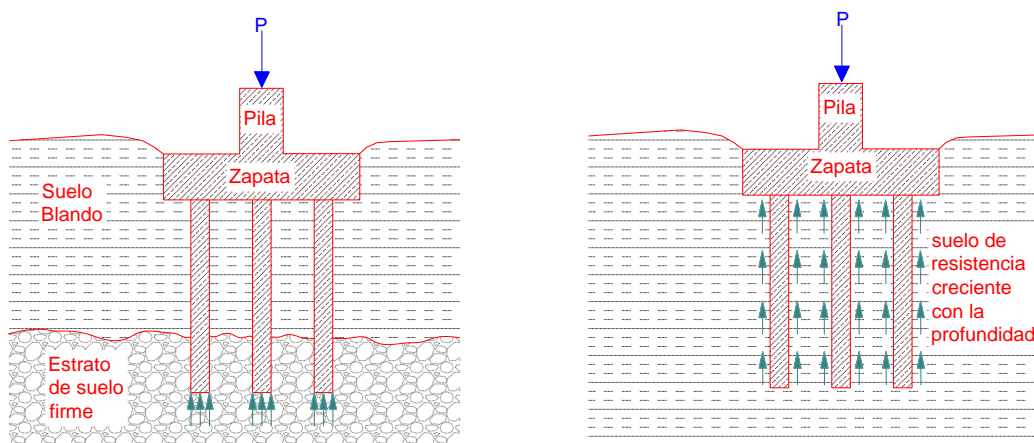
Esquema de cimentaciones con pilotes Hicados o Perforado.
